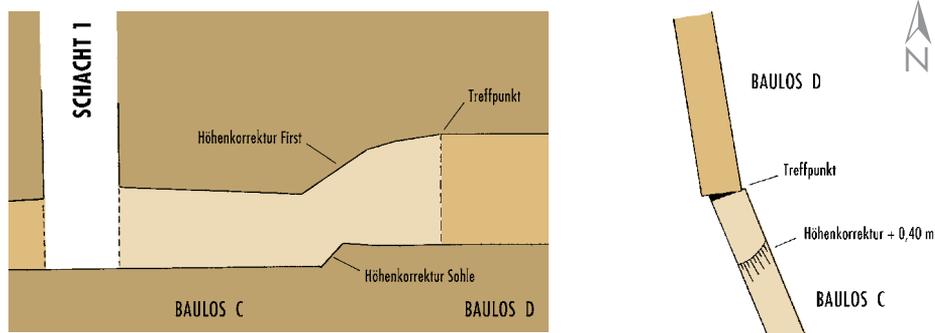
Detail: Treffpunkt Baulos C und D. Grundriß und Längsschnitt. M. 1:100
